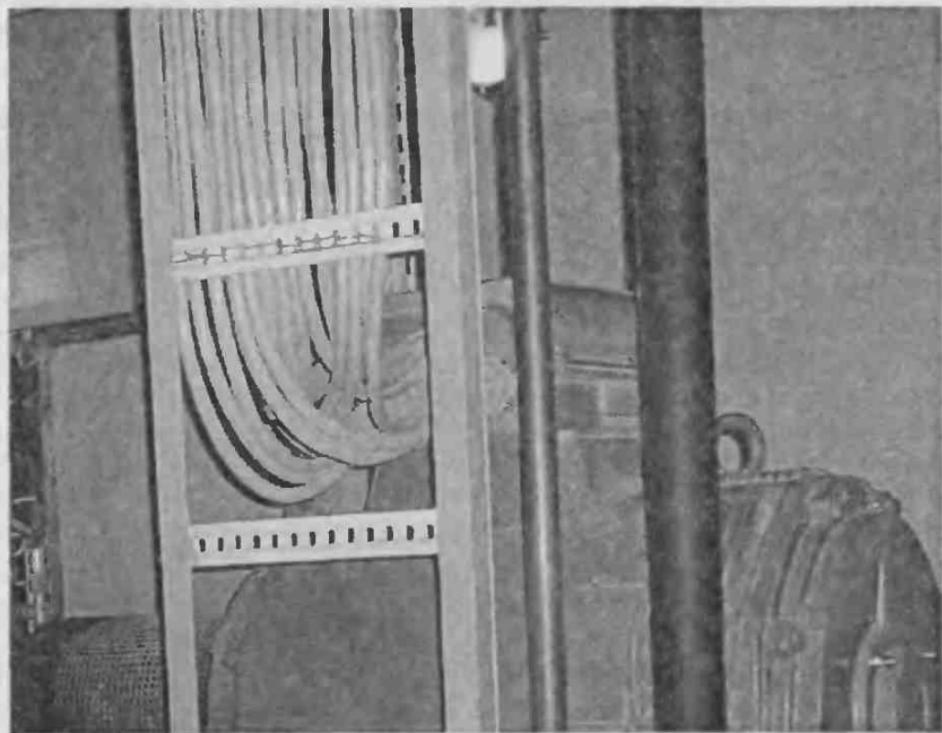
Питание электродвигателя компрессорного агрегата по нескольким кабелям
